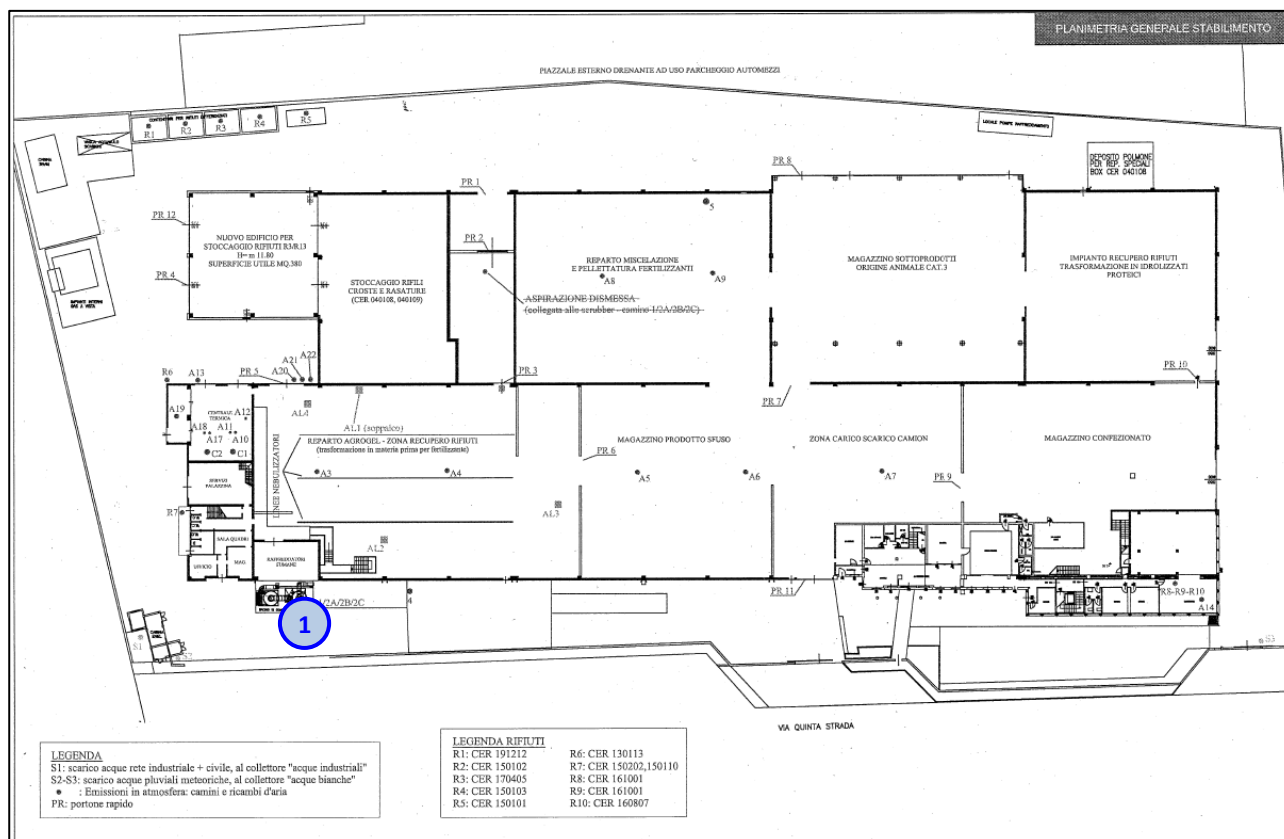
Planimetria dell'impianto ILSA S.p.A.
